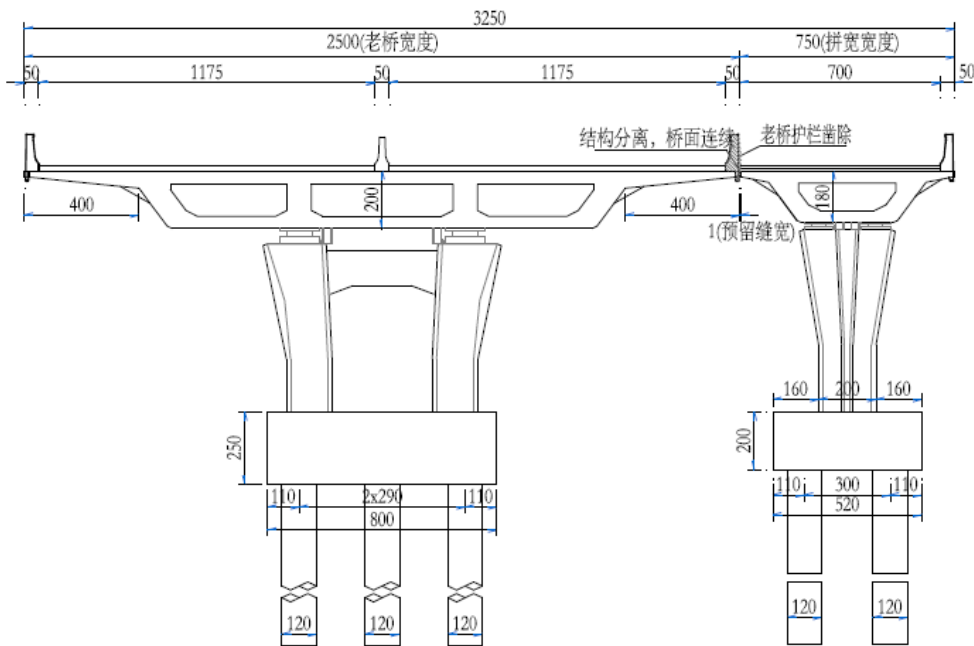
高架五星枢纽优化工程标准横断面图
